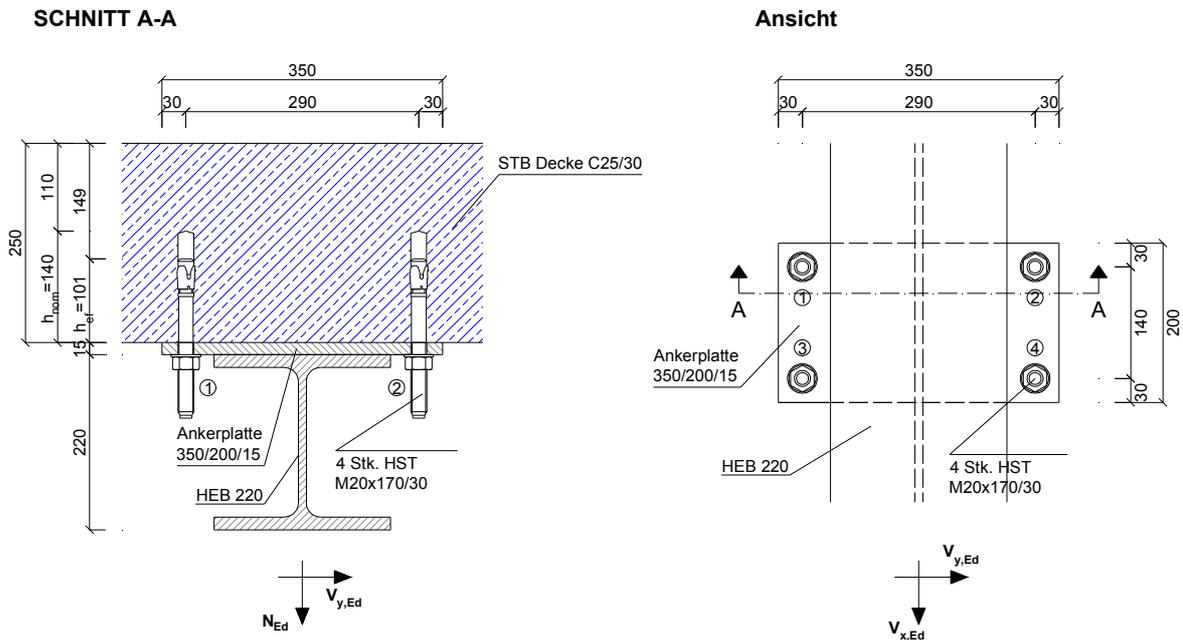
Anschlussdetail K1 Dübel Variante 2 (Maße in mm)
